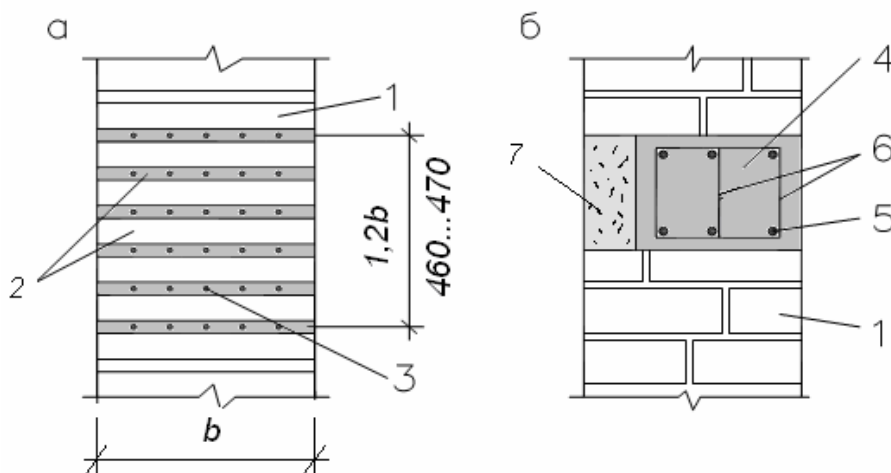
Усиление стен здания поясами: а – армокаменным; б – железобетонным:
